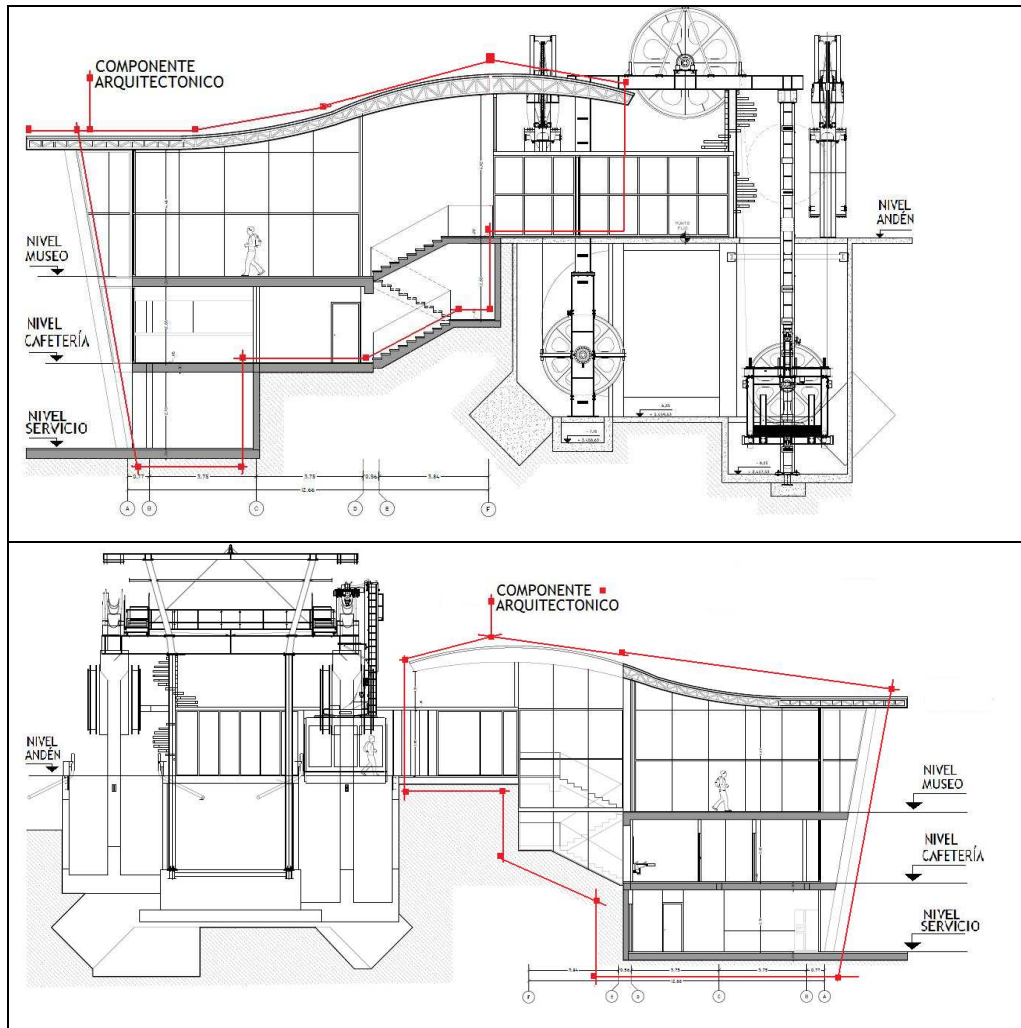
Adaptación, propuesta arquitectónica, componente arquitectónico de la estación, corte transversal desde ambos lados. (Sistema teleférico de Mérida, Departamento de ingeniería y construcción, 2011).
